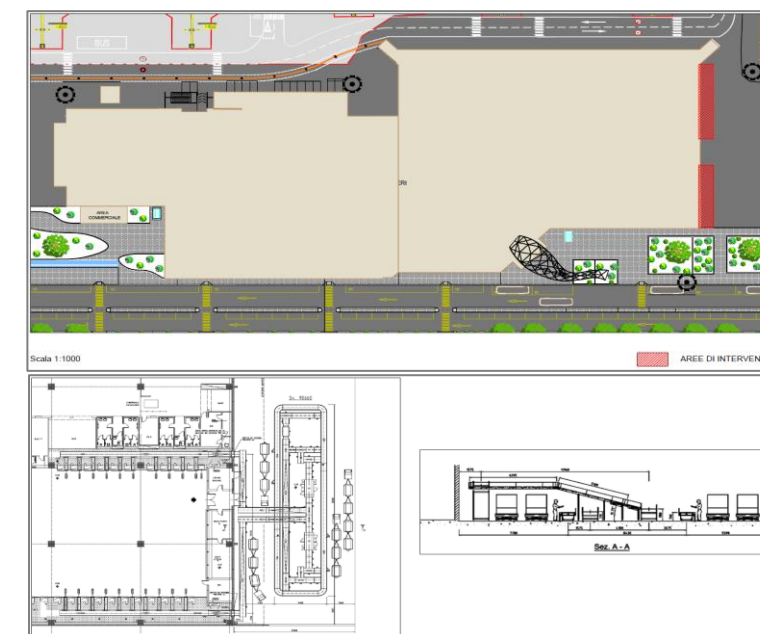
planimetri di intervento di adeguamento capacità BHS
